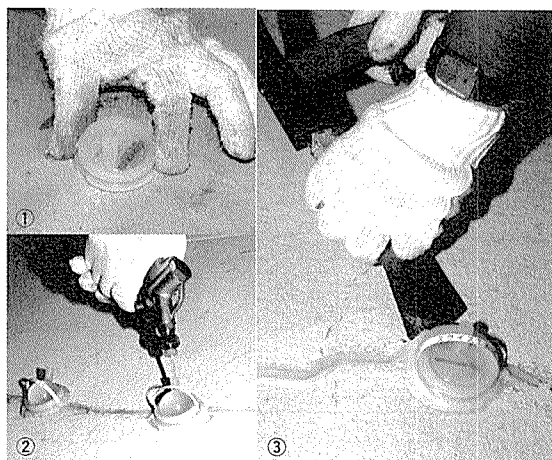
低圧注入工法によるひび割れ補修例⁴⁾
